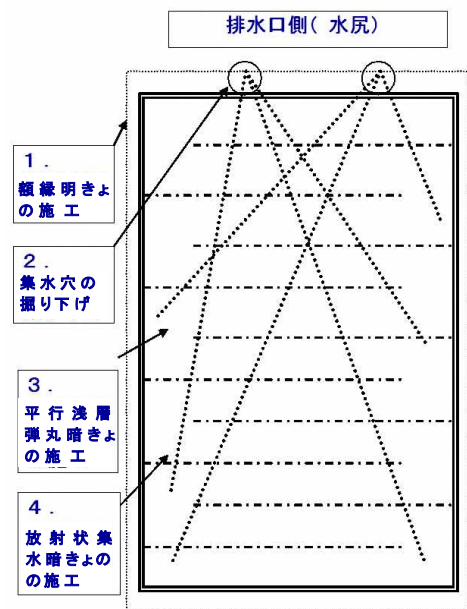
補助暗きよ（弾丸暗きよ）の施工
